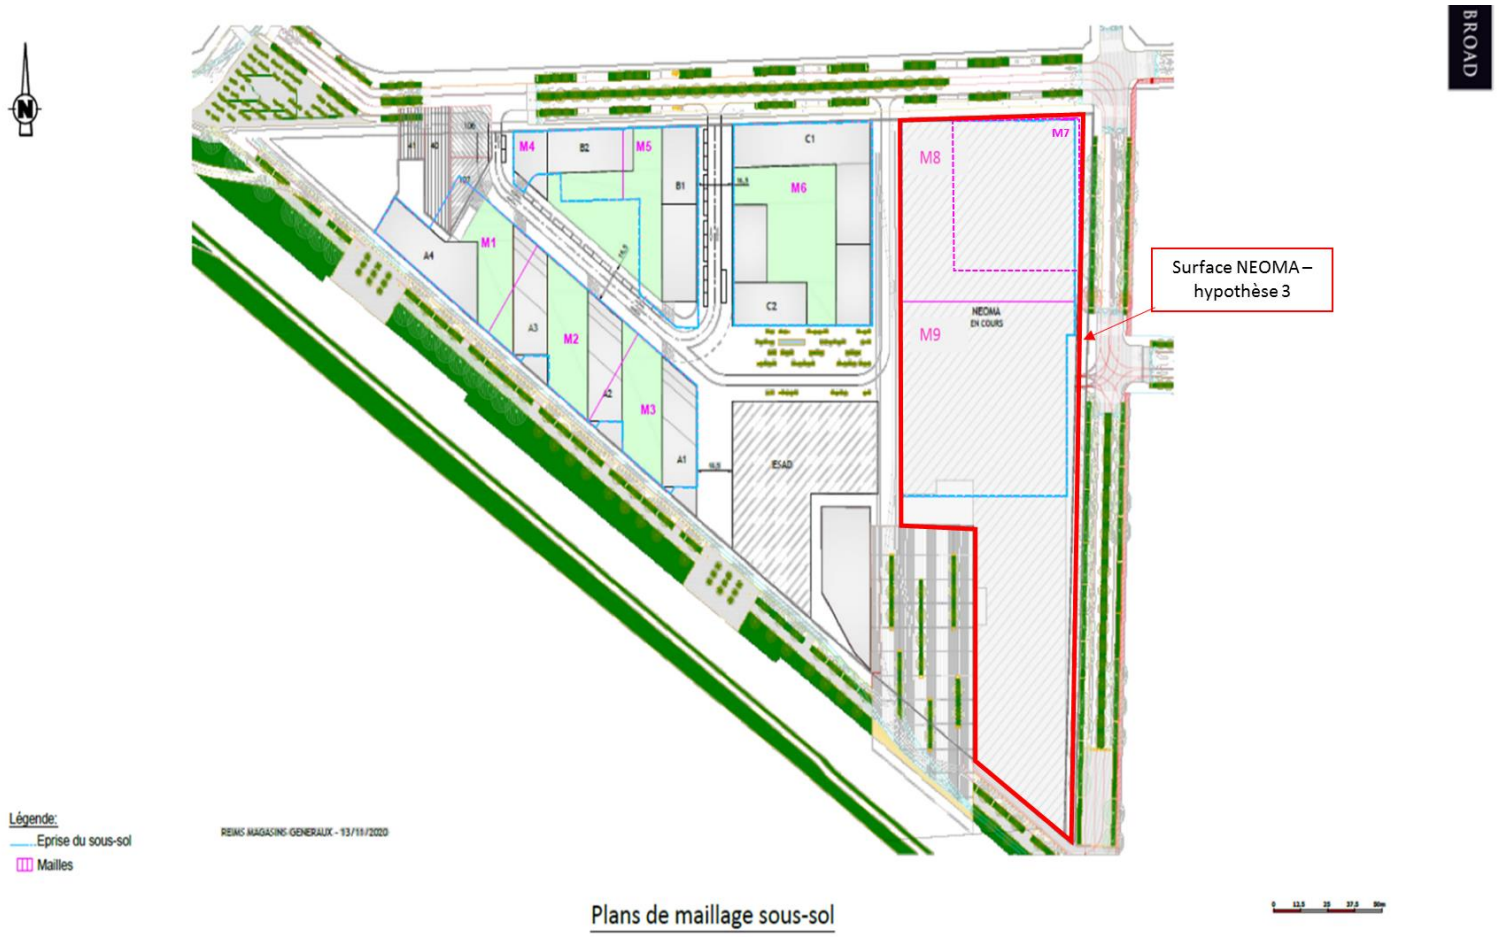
Plan de maillage des sous-sols – NEOMA 1&2
